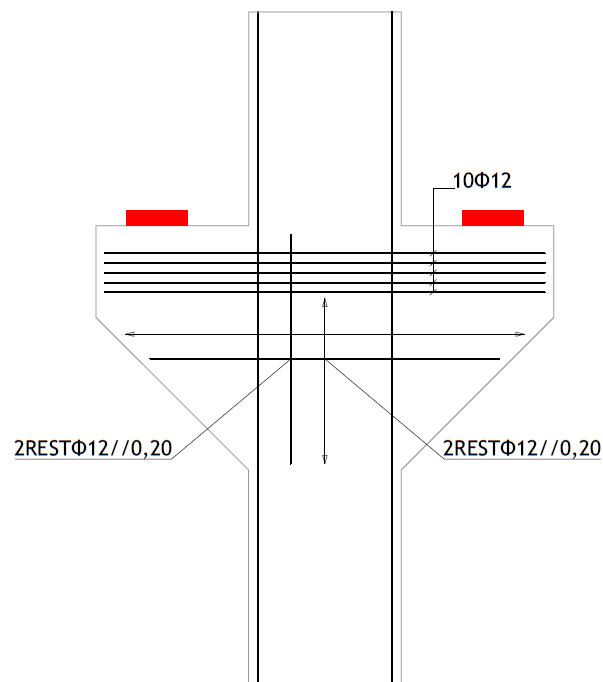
Vista em alçado relativo à pormenorização da armadura principal e suplementar do conjunto das consolas curtas.
